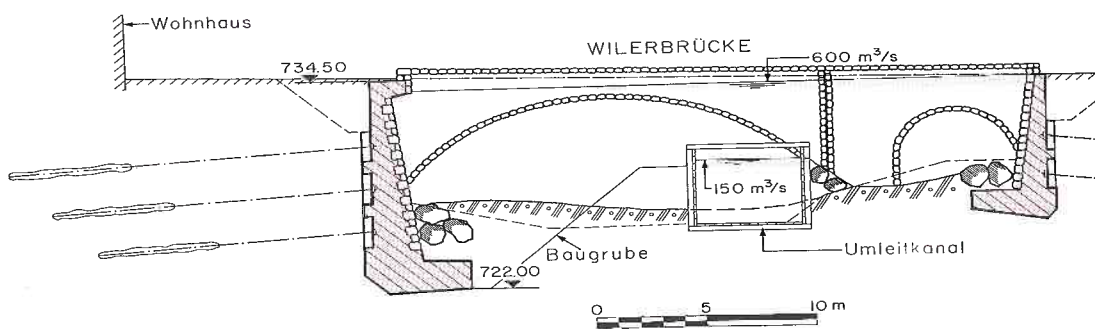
Ufermauern bei der Wilerbrücke, Baugrube und Baumleitung für Hauptschutzelement C (links).
